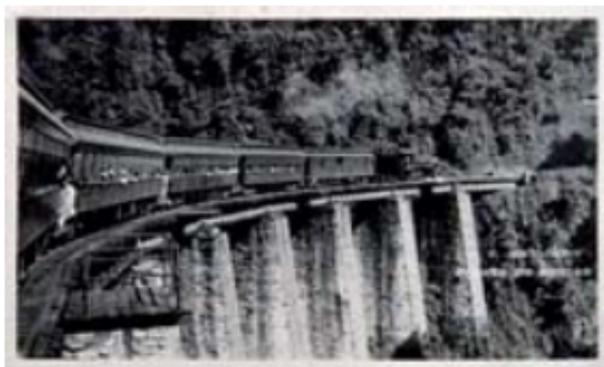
El puente de Metlac donde los pilares ya estaban recubiertos de concreto, antes de 1940
